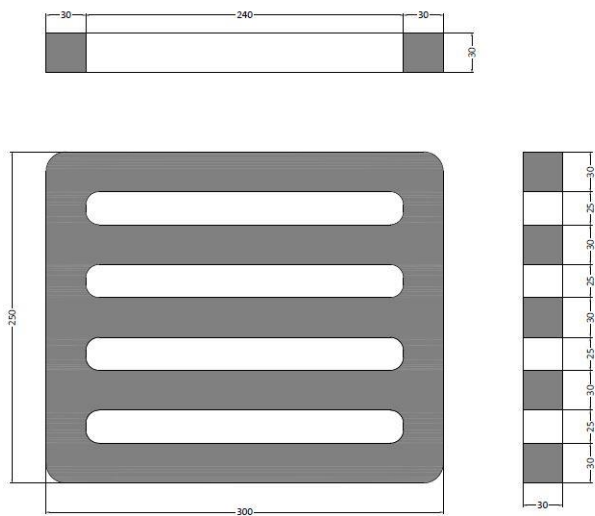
Geometría de los imbornales elegidos (cotas en mm)
